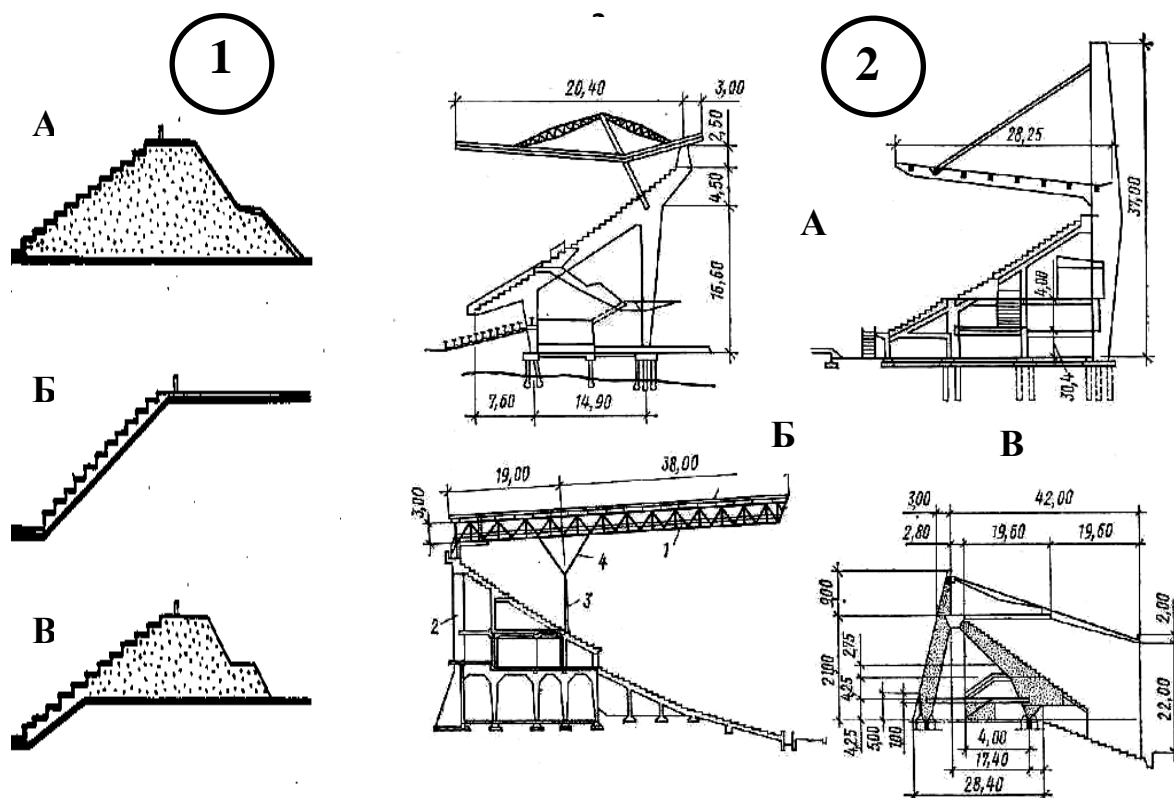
Примеры конструктивных решений трибун стадионов: 1- на грунте: А-на грунтовом насыпном основании, Б – на естественном склоне, В- на валу:
